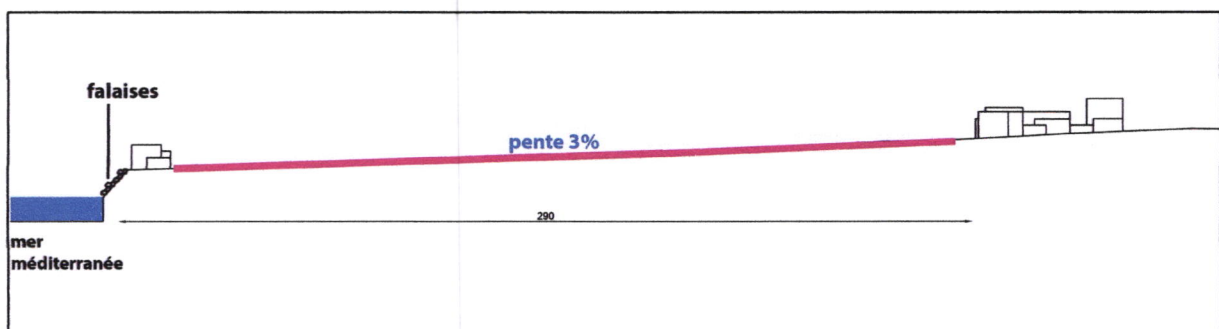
06 : Coupe schématique sur le terrain d'intervention.
